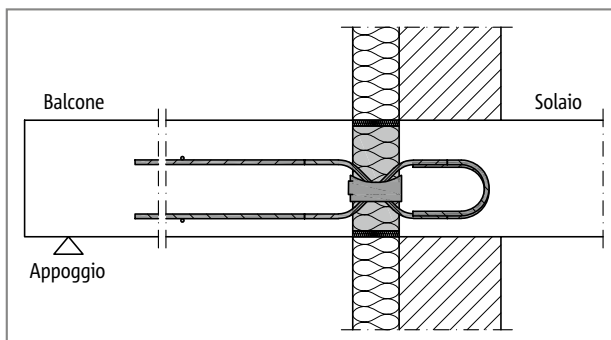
Schöck Isokorb® T tipo QL-VV: raccordo con sistema di isolamento a cappotto
